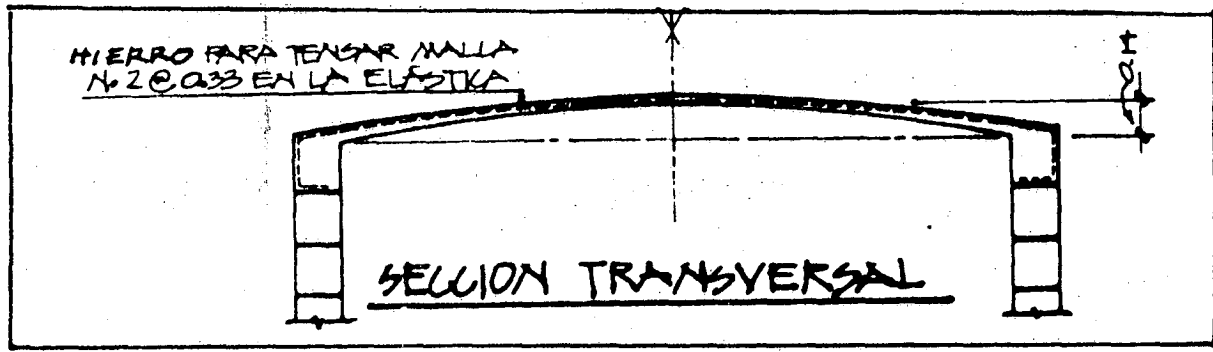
Muestra la sección transversal en las cubiertas abovedadas.
